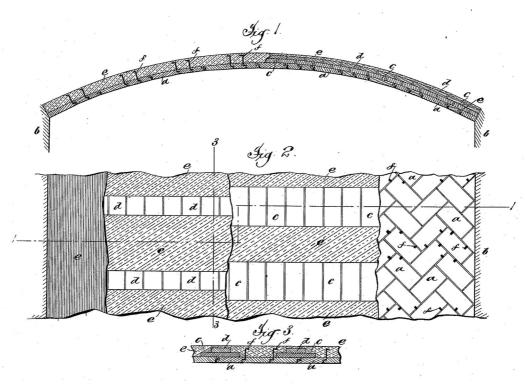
Rafael Guastavino Expósito, 1892. Construction of Fire Proof Buildings, 01. Fuente: US Patent Nº 468871, February, 1892.
